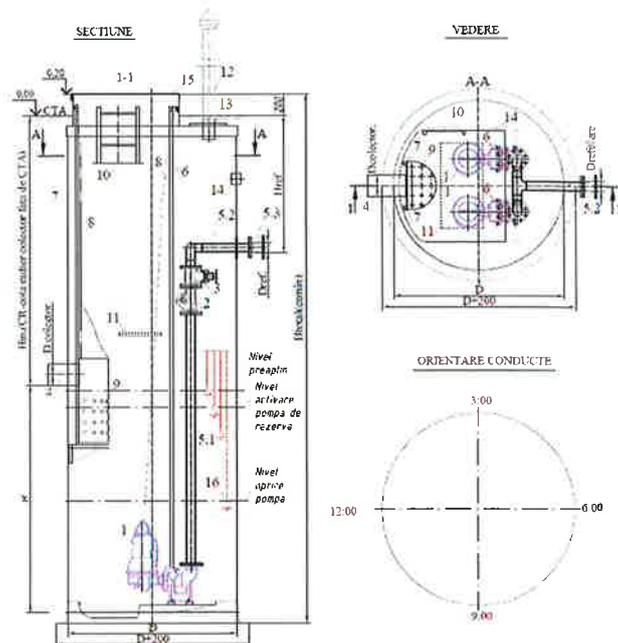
Cămin echipat cu pompe montaj imersat si configurat pentru montaj in zona verde. Secțiune și vedere generală
